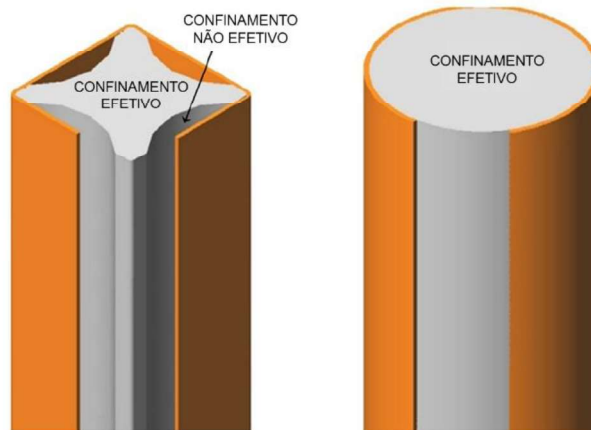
Confinamento efetivo do concreto em pilares mistos de aço e concreto.
